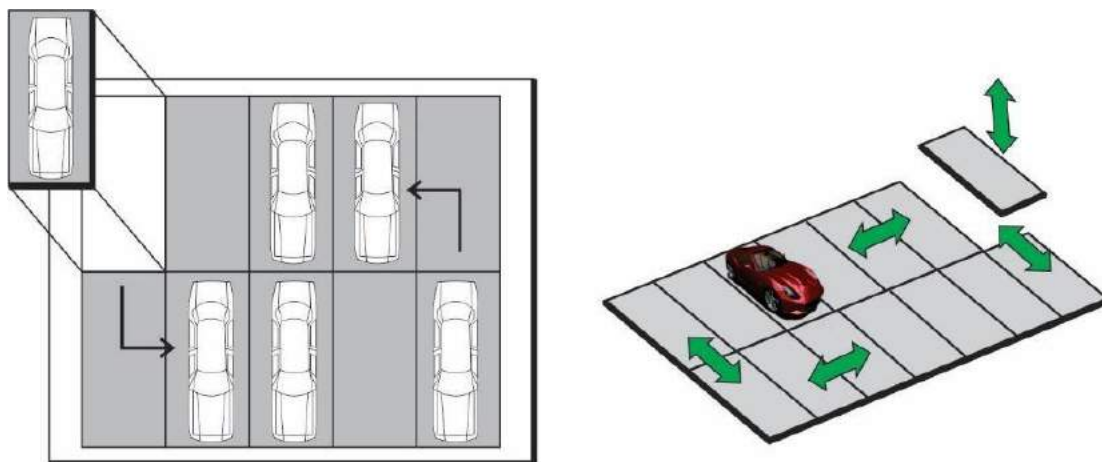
Contoh tipe masuk dari samping pada box type convey parking dengan akses samping
